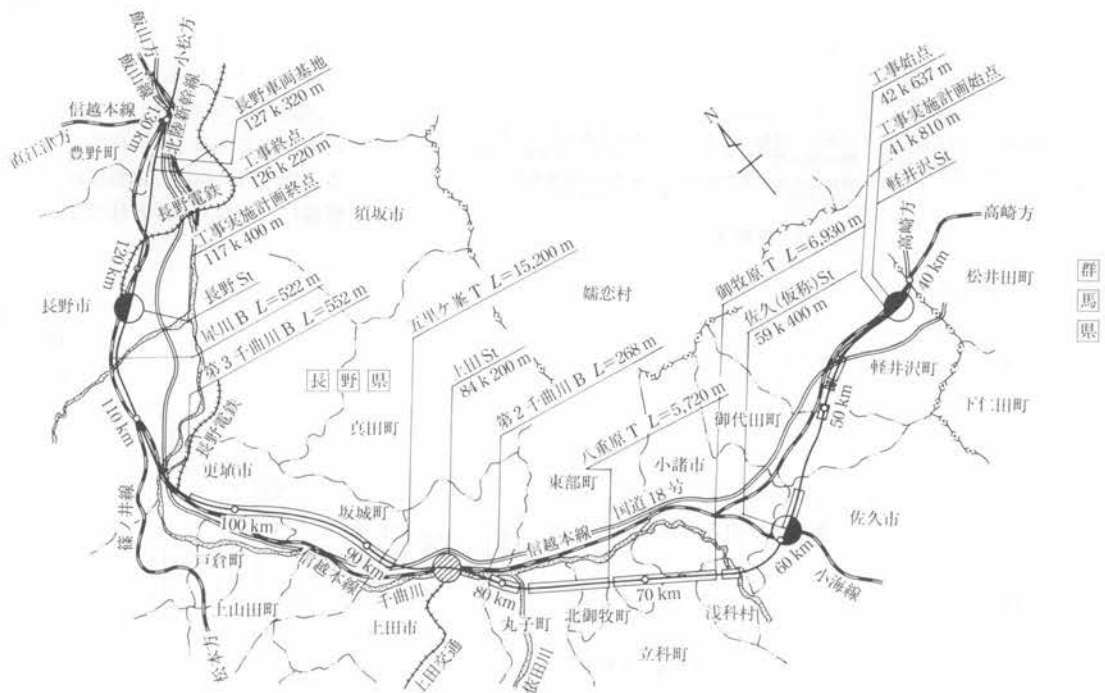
北陸新幹線(軽井沢・長野間線路平面図)
